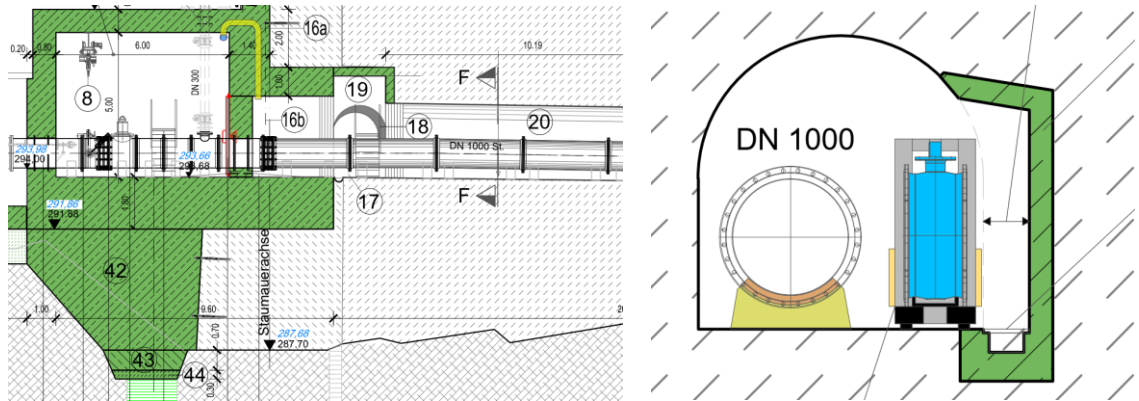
Demontage-/Montage der Armaturen und Grundablass-Leitungen
